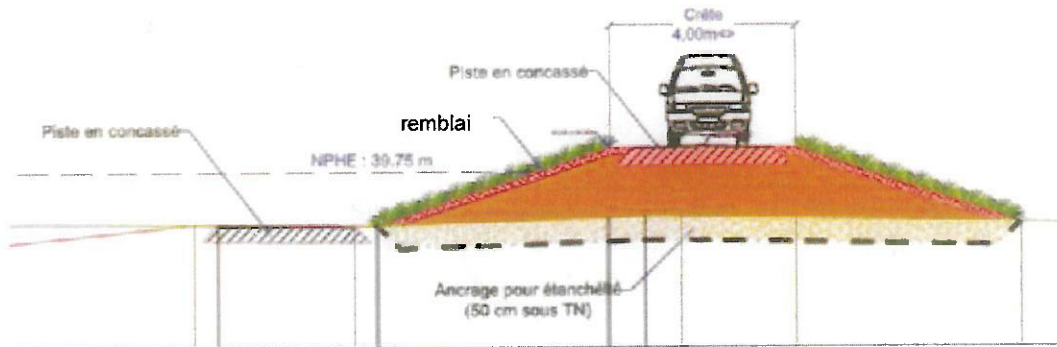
Extrait du plan de masse – Coupe en travers du corps d'ouvrage.
